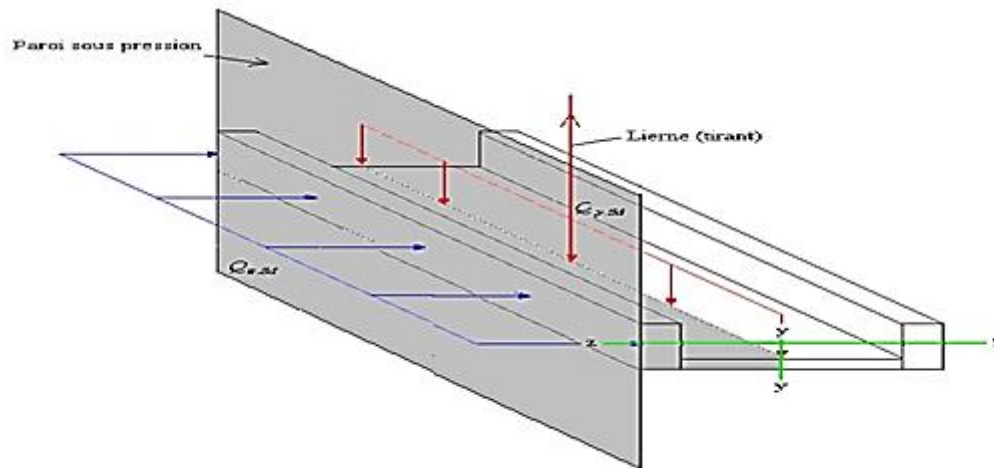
Semelle comprimée soutenue sur toute sa longueur.
